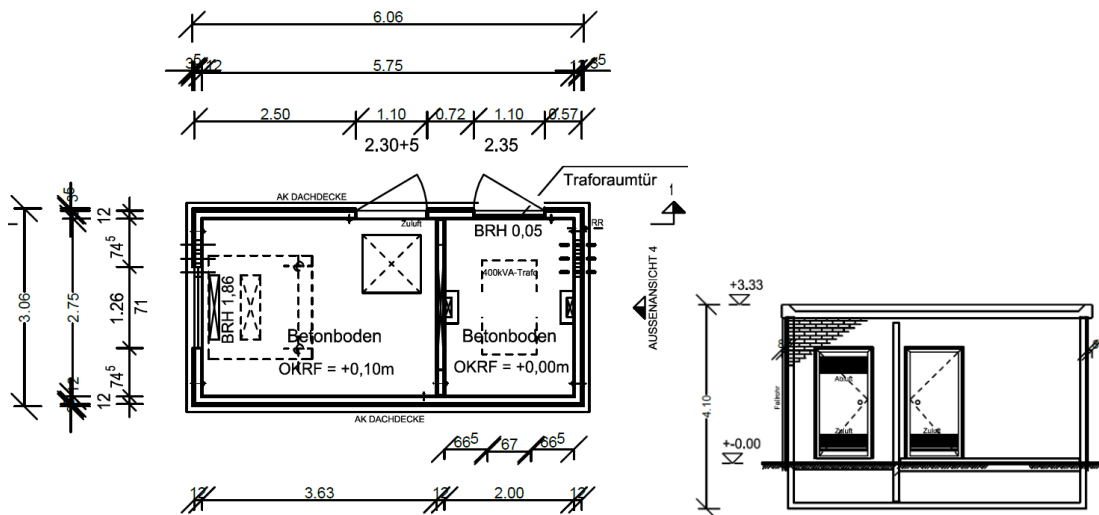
Geplantes 30-kV-Eigenbedarfsgebäude (links: Grundriss, rechts Seitenansicht)
